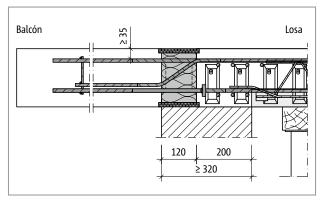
Schöck Isokorb® XT tipo C: Placa prefabricada con apoyo periférico con muro aislante (sección XT tipo C-L-CV35, vista XT tipo C-R-CV50)
